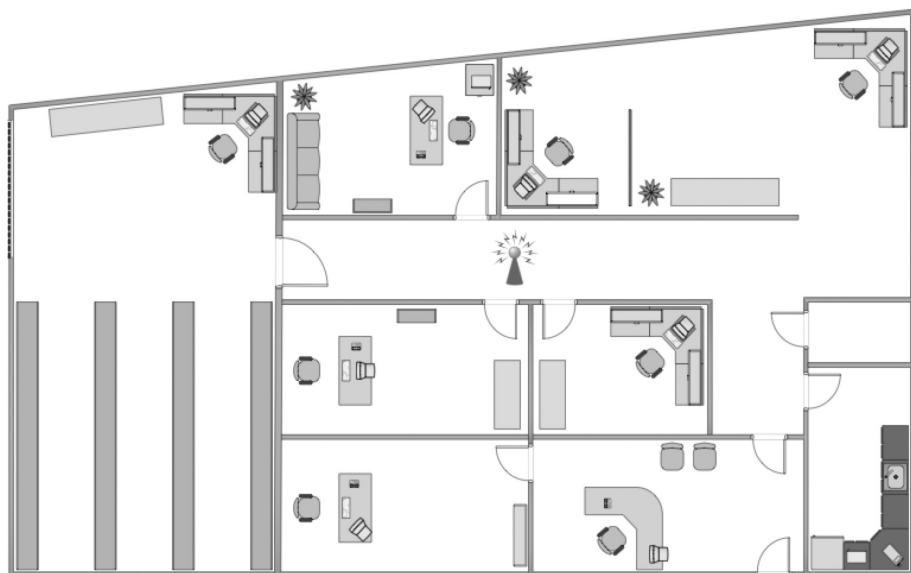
Grundriss einer Wohnung mit zentralem WAP
